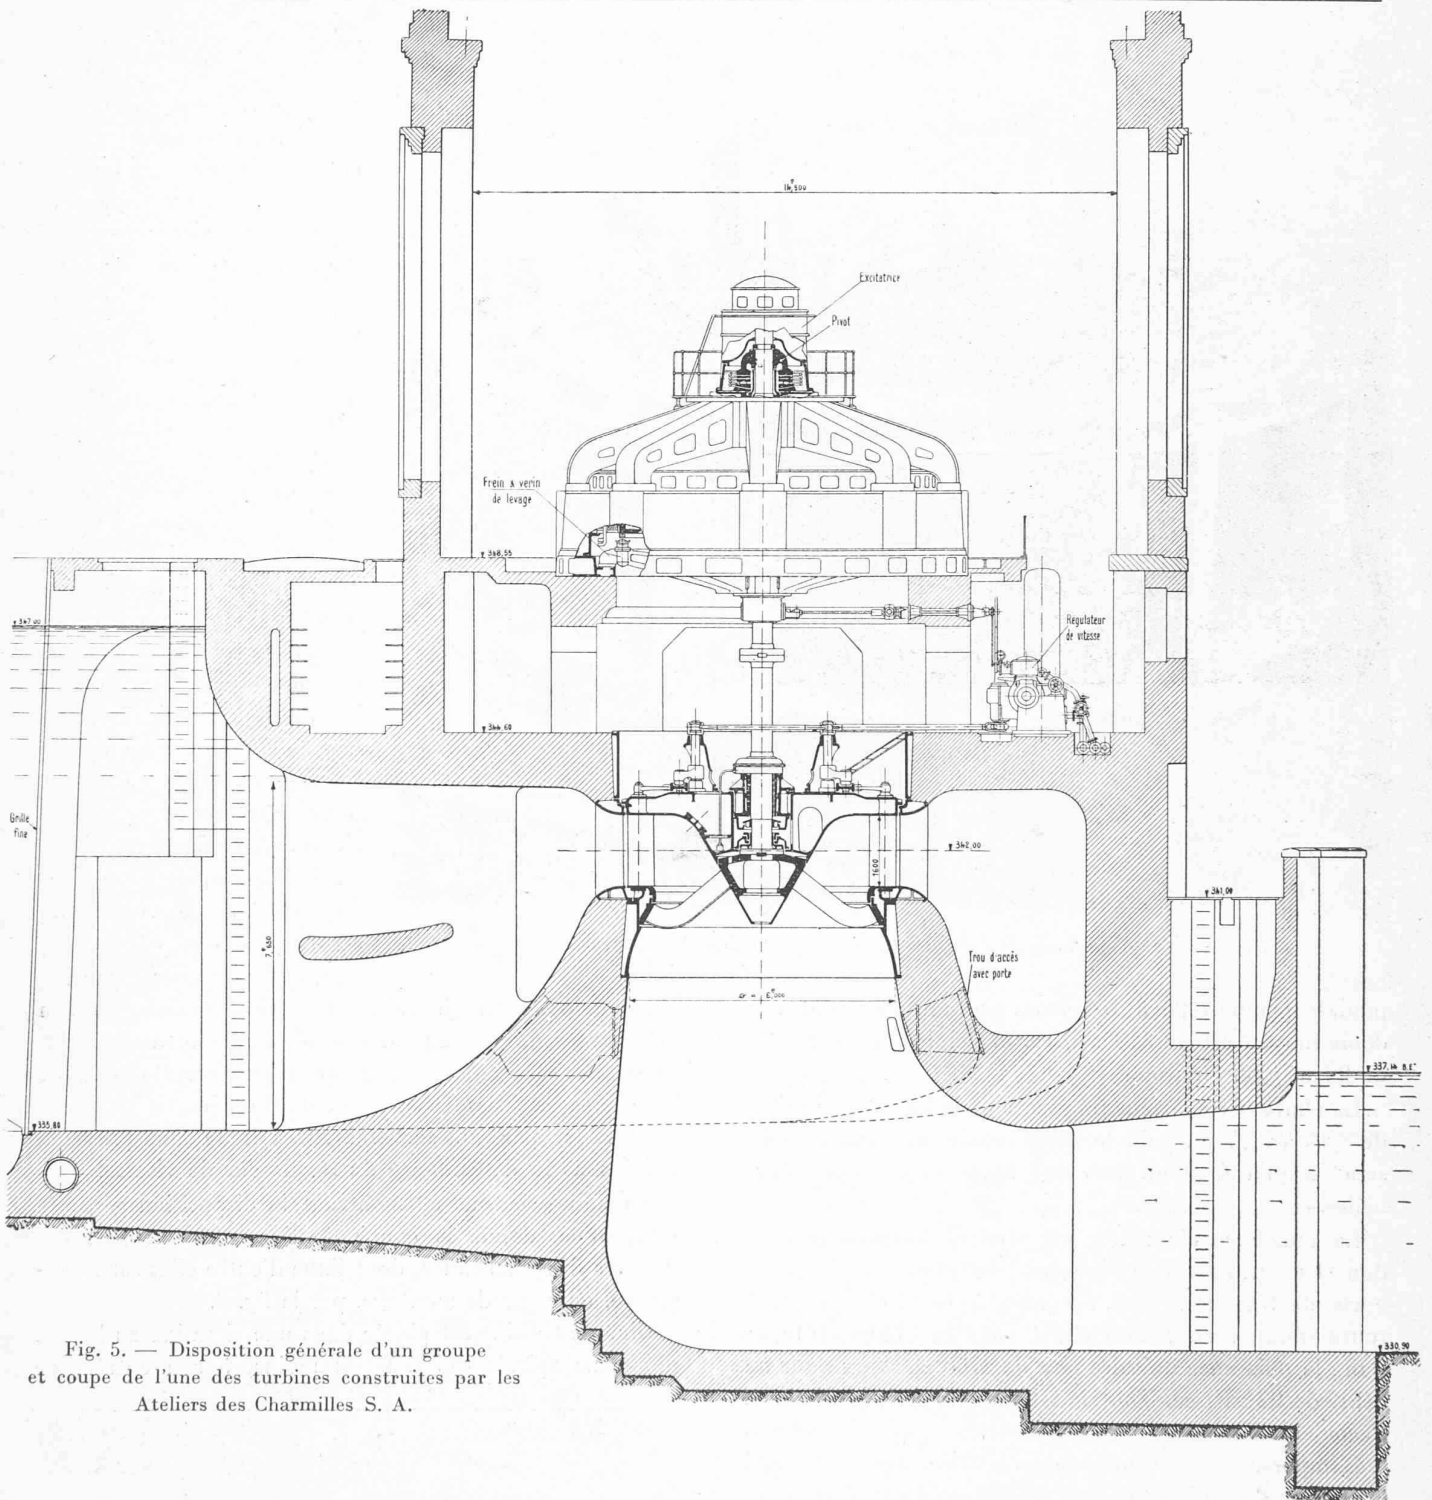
Disposition générale d'un groupe et coupe de l'une des turbines construites par les Ateliers des Charmilles S. A.
